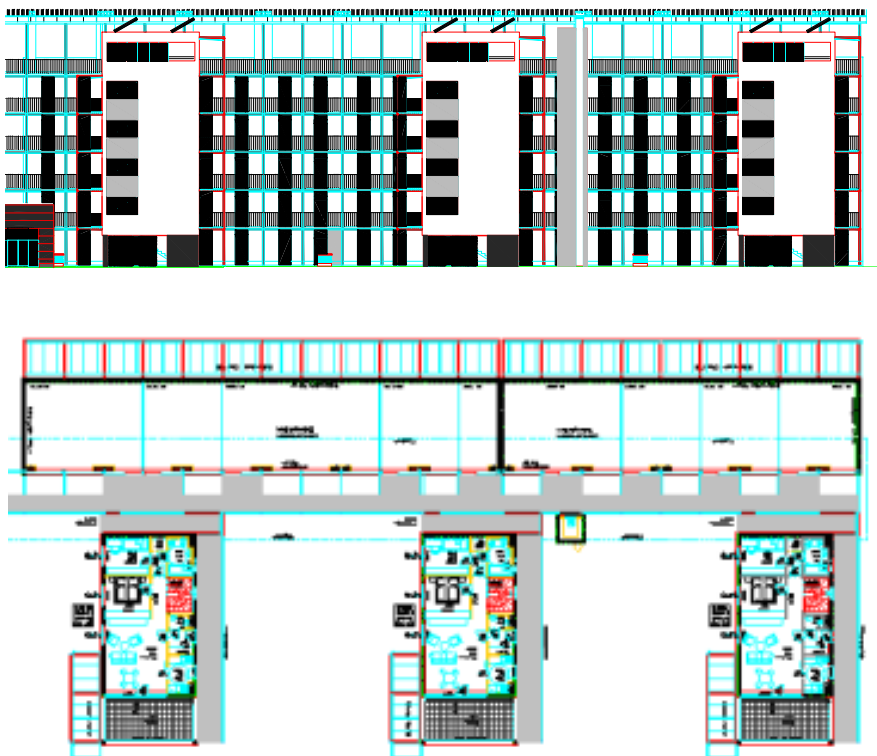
Ostansicht und Grundriss des Demonstrationsobjektes „Sandgasse“ (1. Bauabschnitt, Bildquelle: Architekt Tschom)
